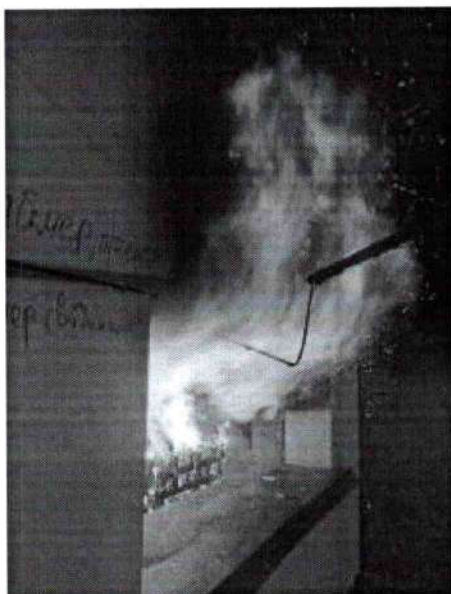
Образец навесного фасада при испытании и в конце испытания по ГОСТ 31251-2008.
